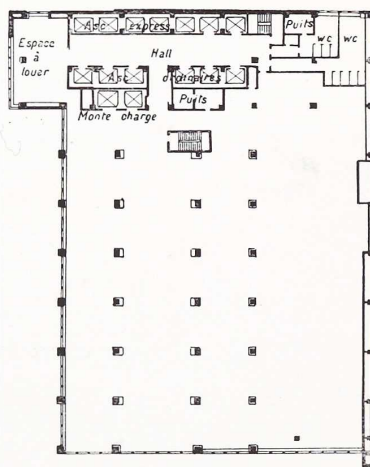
Plan des 2^e, 3^e et 4^e étages.
